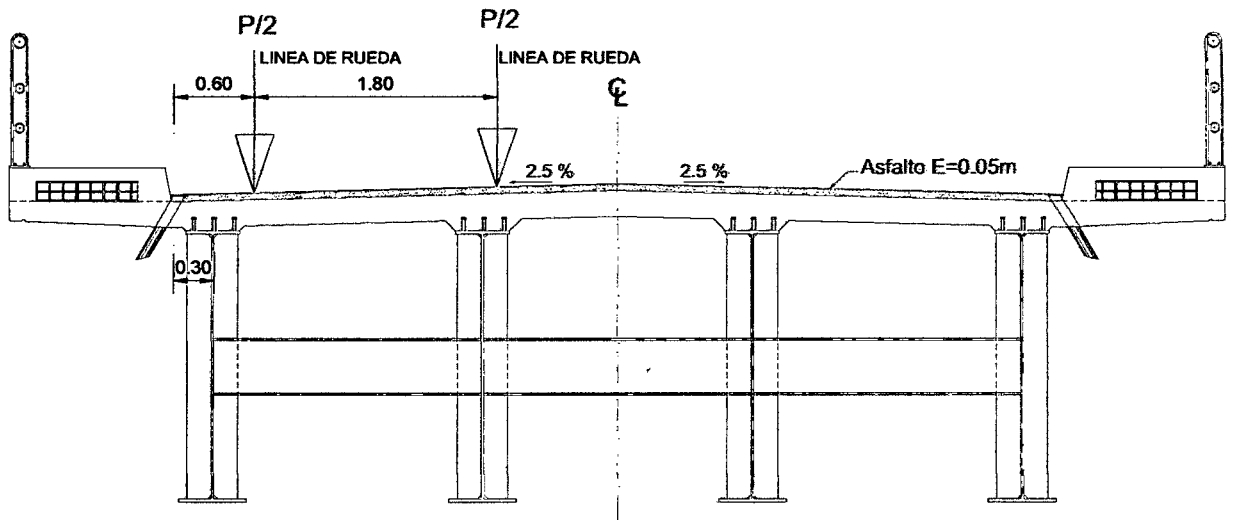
Ubicación de los ejes del Camión en la sección transversal del Puente
